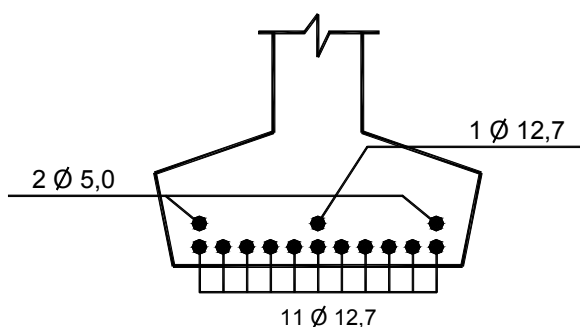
Armadura de flexão da aplicação nº 2.
